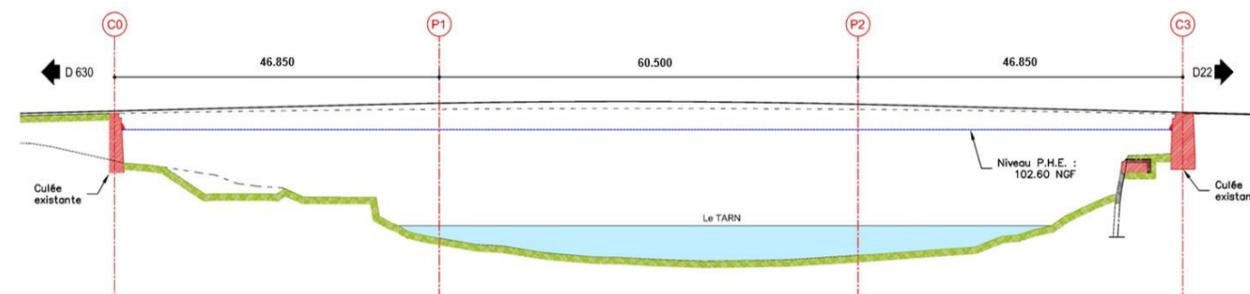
Profil en long avec les lignes d'appuis - Extrait Mémoire technique (Ingérop)
